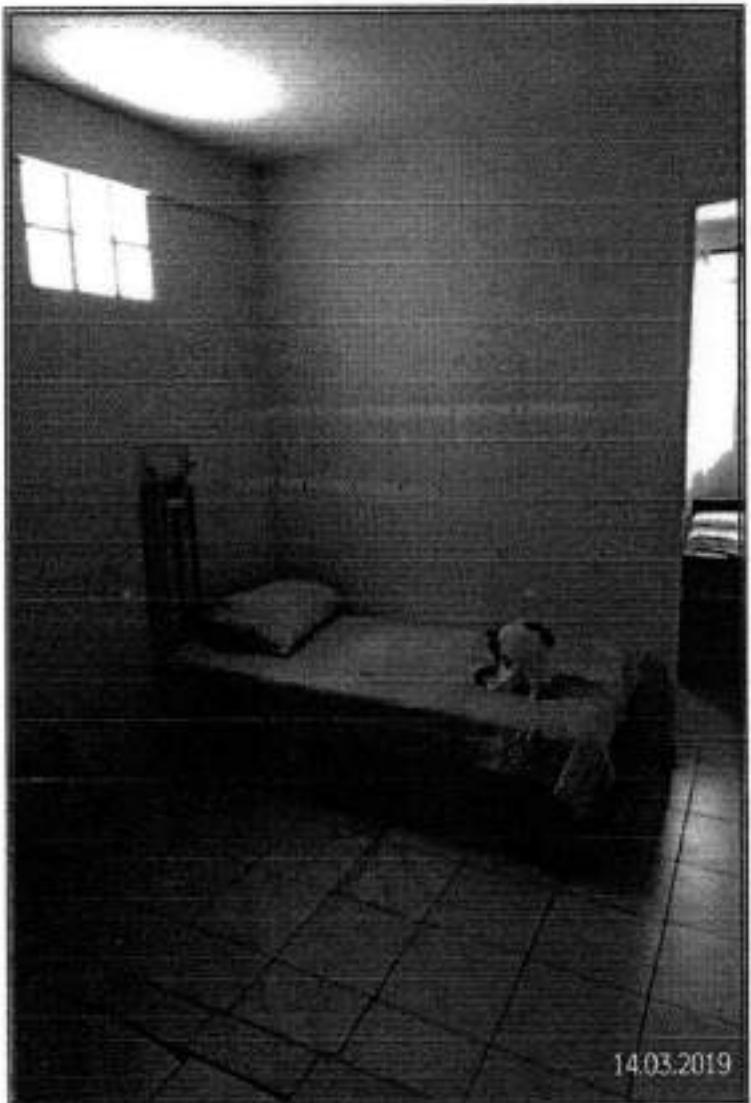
Vista parcial do dormitório 01, proveniente da subdivisão de fechamento da parede da sala.
